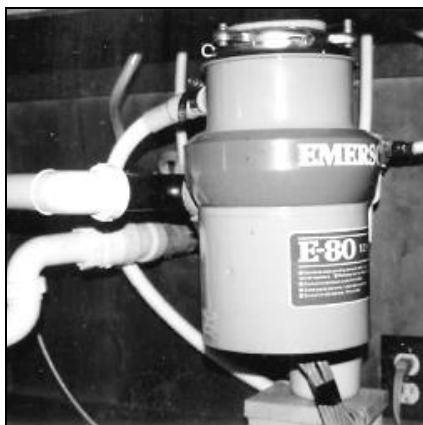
Соедините сливное колено (показано слева черным) измельчителя со сливной трубой мойки
